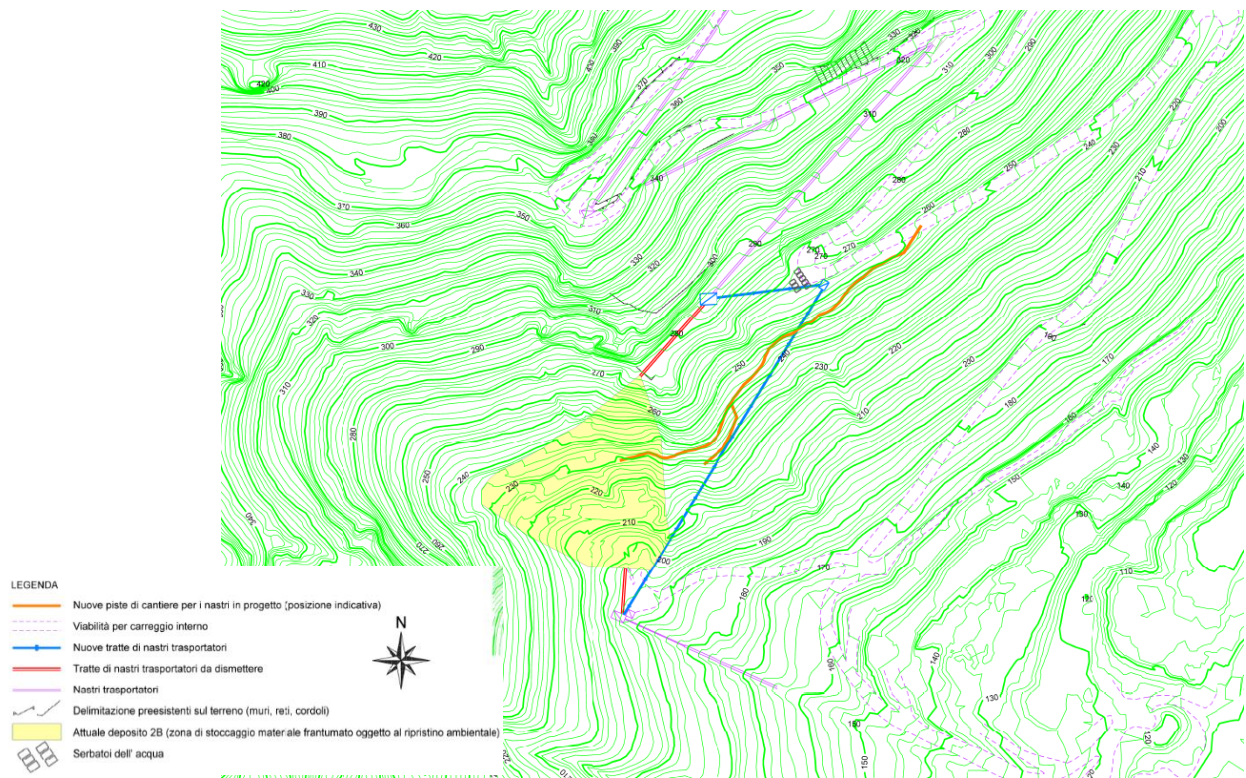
Estratto della planimetria generale – progetto autorizzato - nastri
